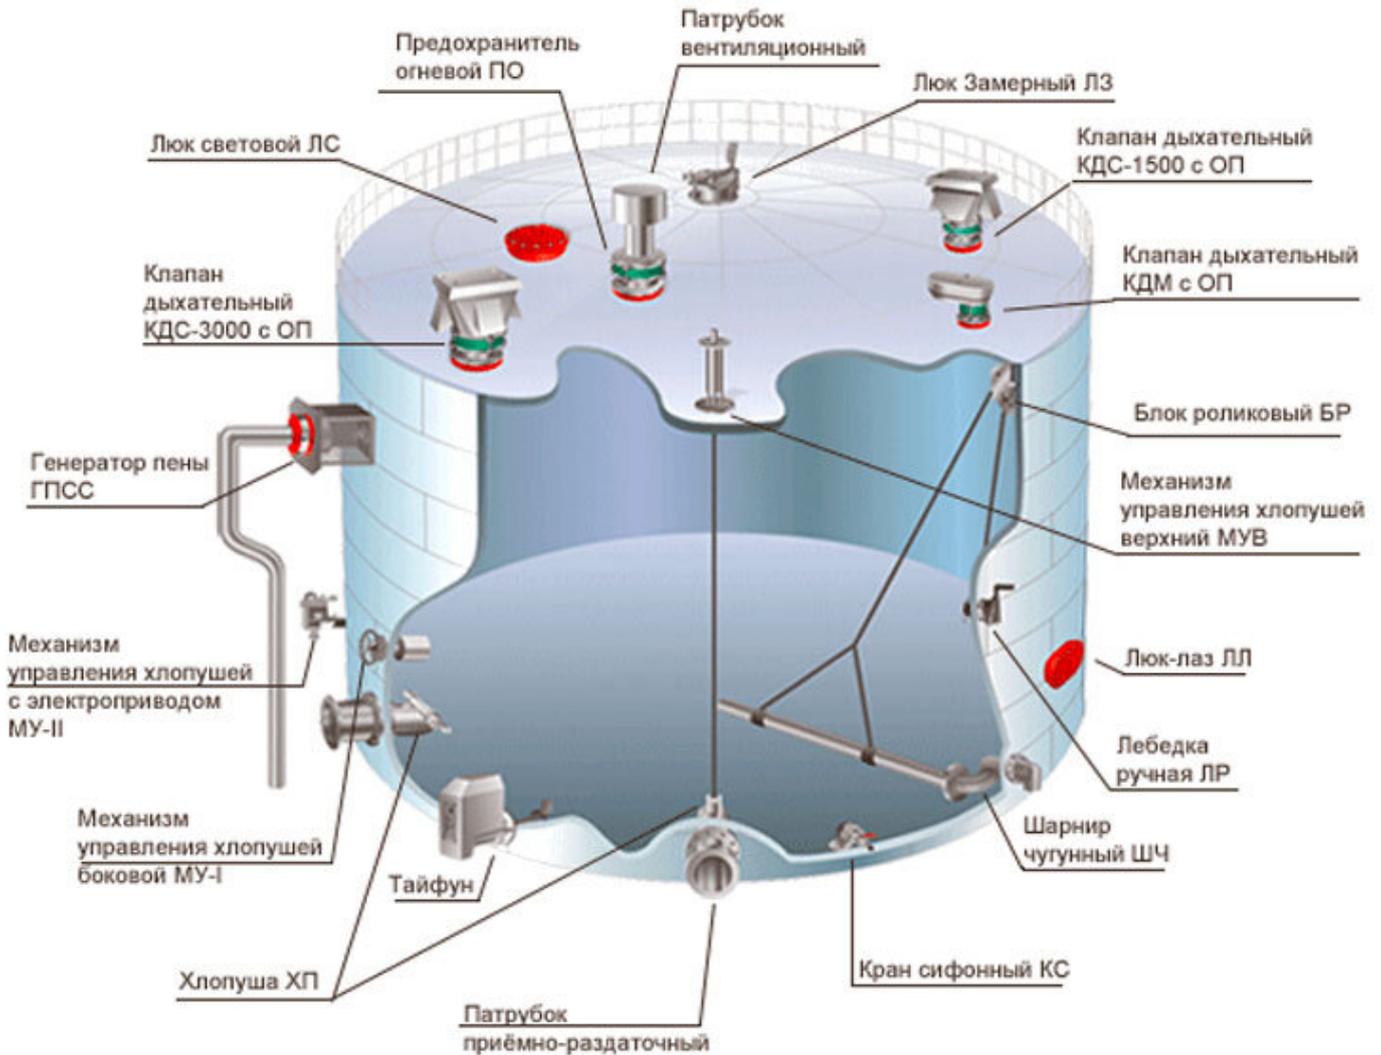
Схема расположения оборудования стальных цилиндрических резервуаров
